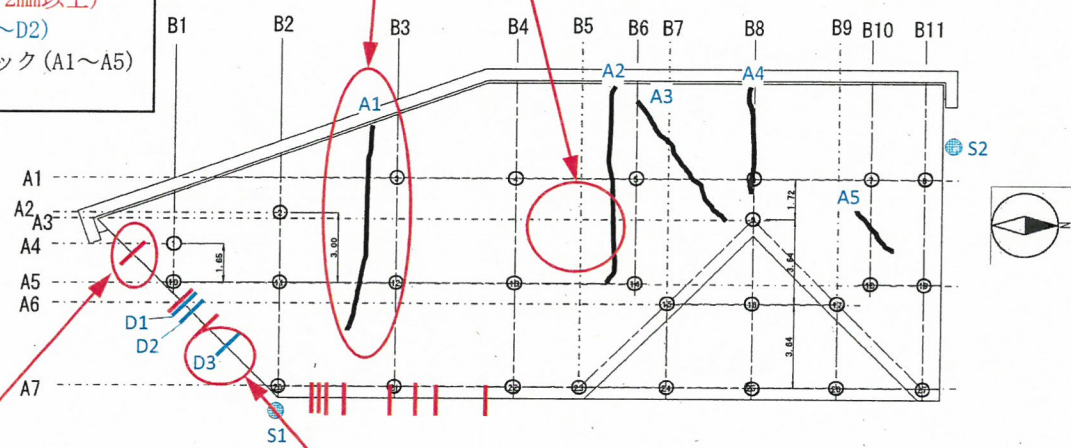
搬出入施設・車両乗降部 平面図 (上部工)
